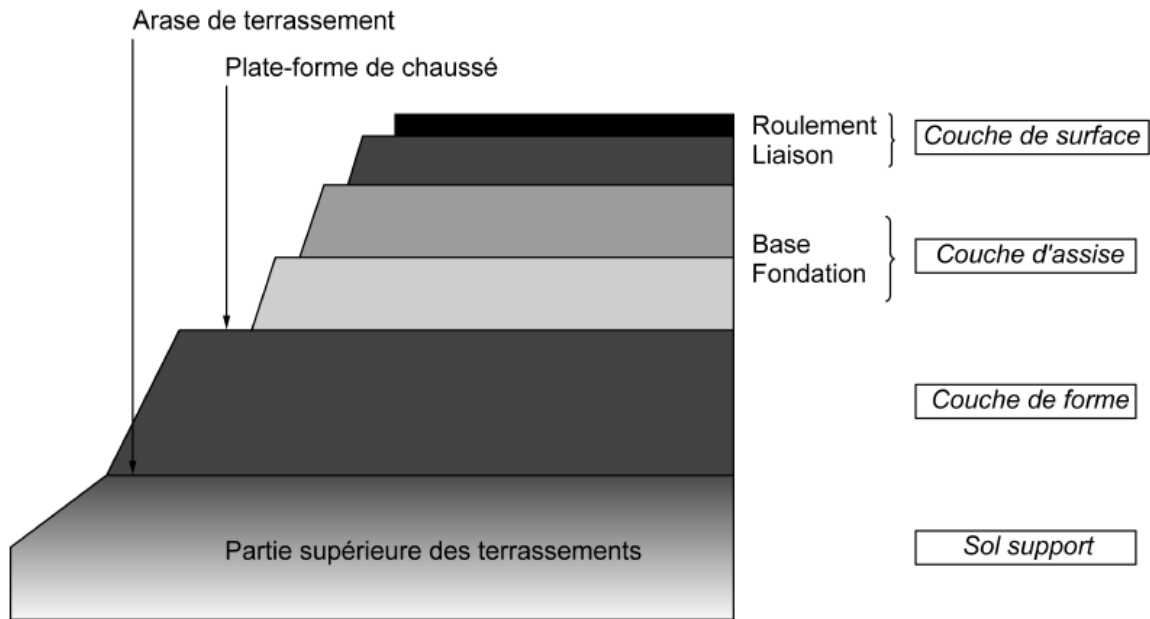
Coupe verticale d'une structure de chaussée (NF P 98-086, 2011)
